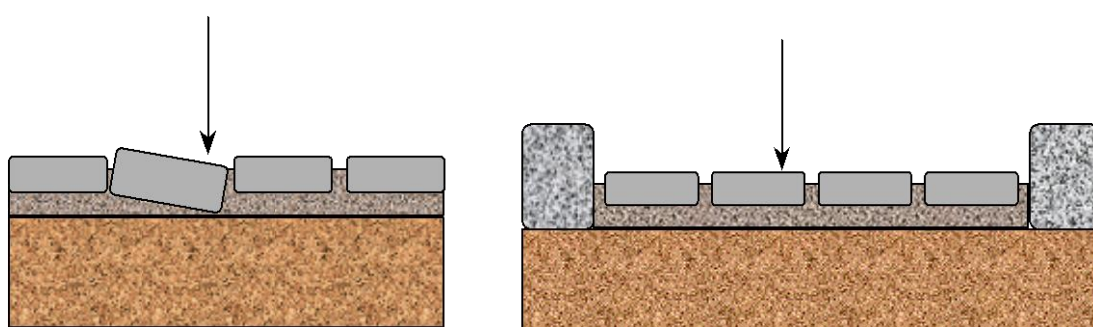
Movimento de rotação das peças pré-moldadas de concreto (HALLACK, 1998).
